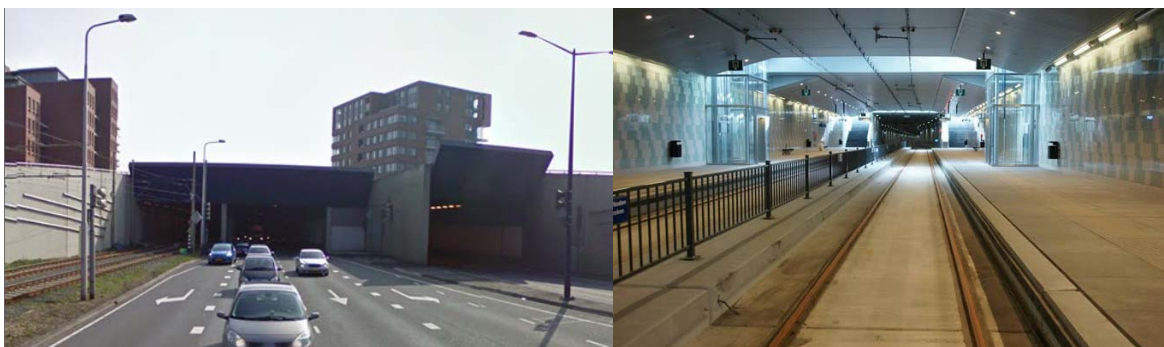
tunnel de Vliet: tunnel routier et tunnel ferroviaire Figure 3: station ferroviaire souterraine
